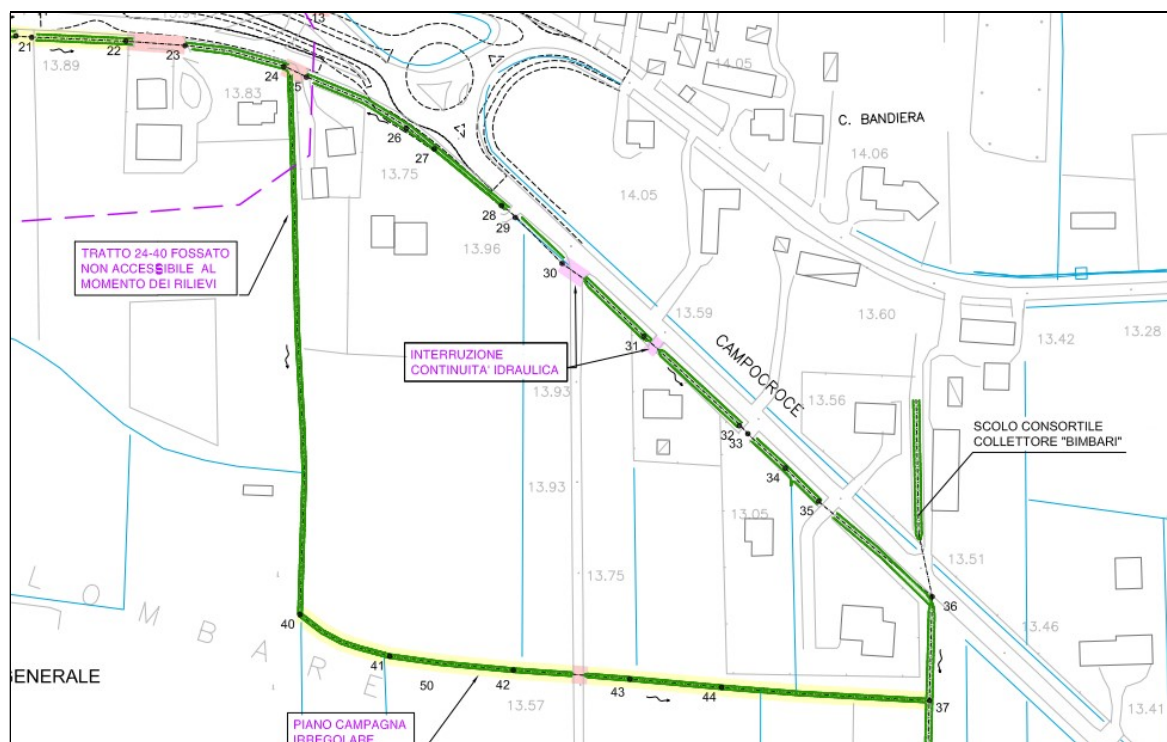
Estratto dall'allegato 3 del Piano degli Interventi comunale - planimetria
